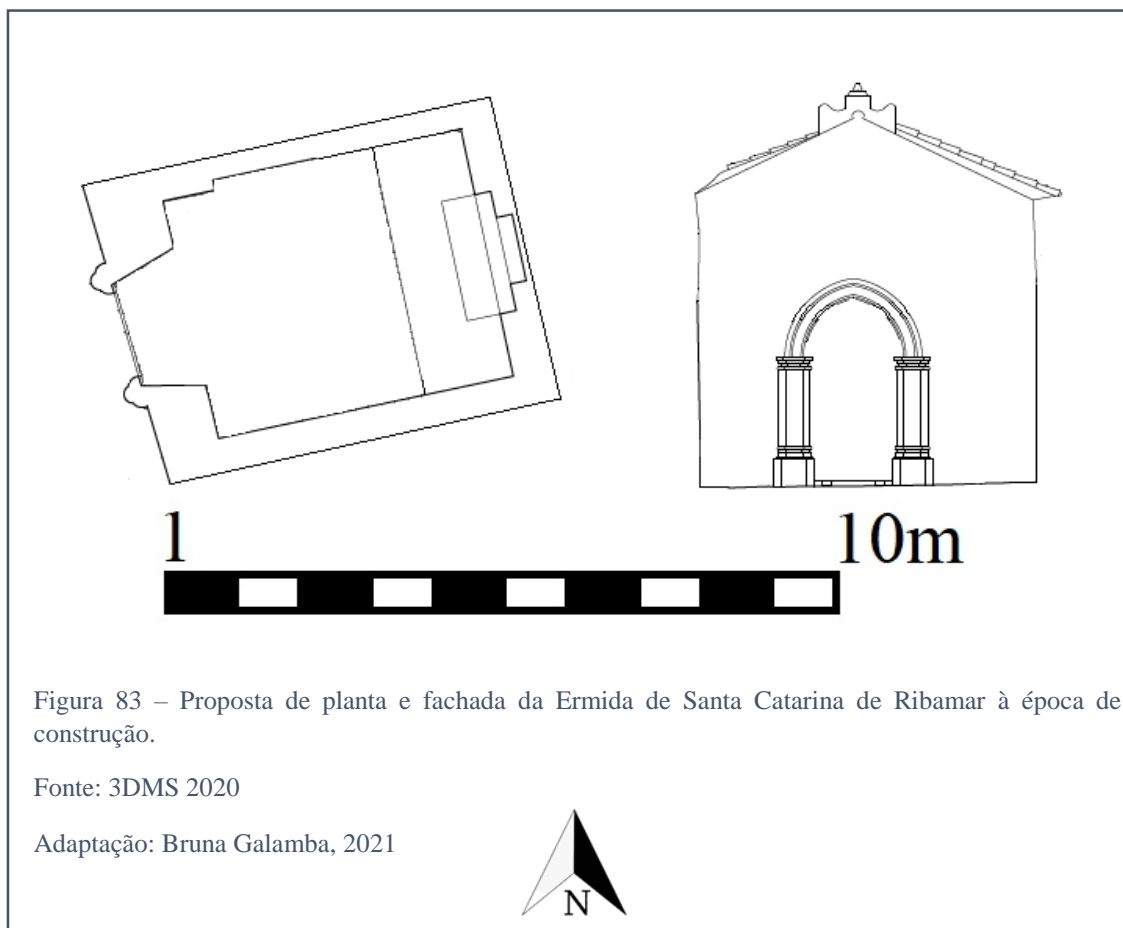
Proposta de planta e fachada da Ermida de Santa Catarina de Ribamar à época de construção.
